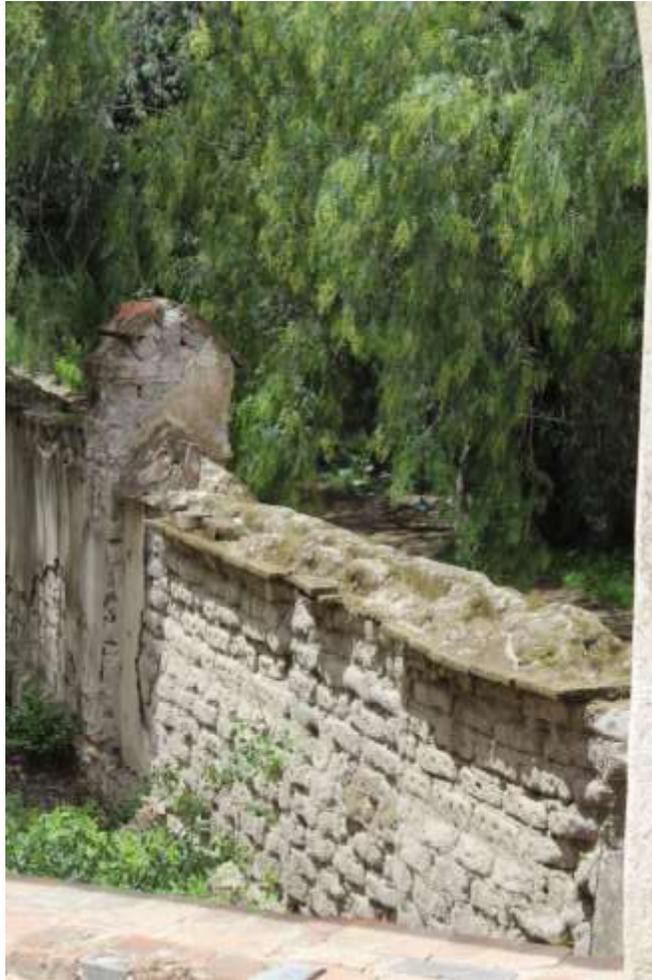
CONSTRUCCIONES ADOSADAS HACIENDA DE PARDO
